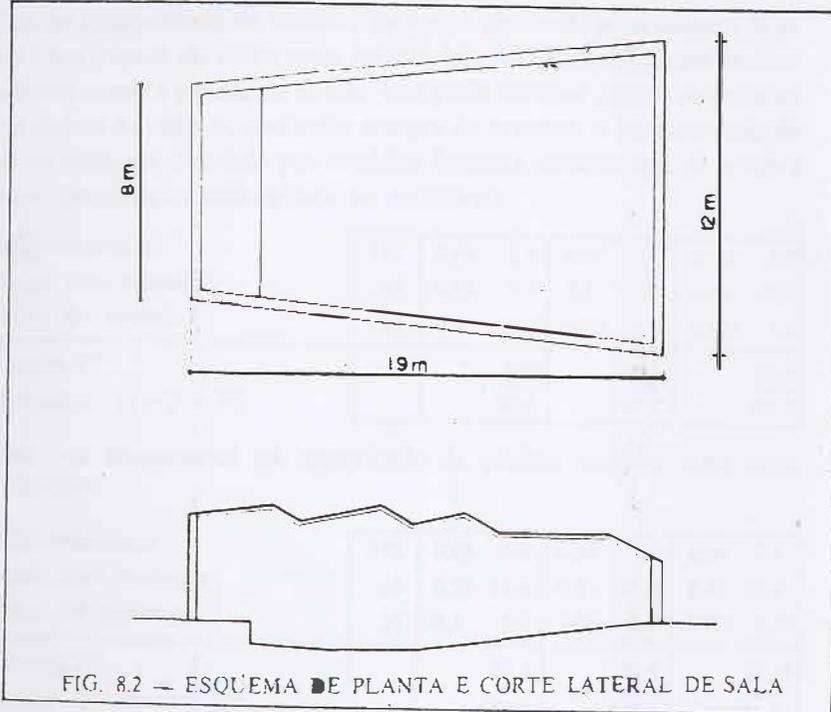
ESQUEMA DE PLANTA E CORTE LATERAL DE SALA
